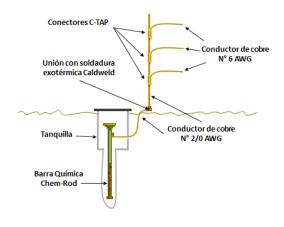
Conexión del bajante a la barra de puesta a tierra Fuente: Autores
